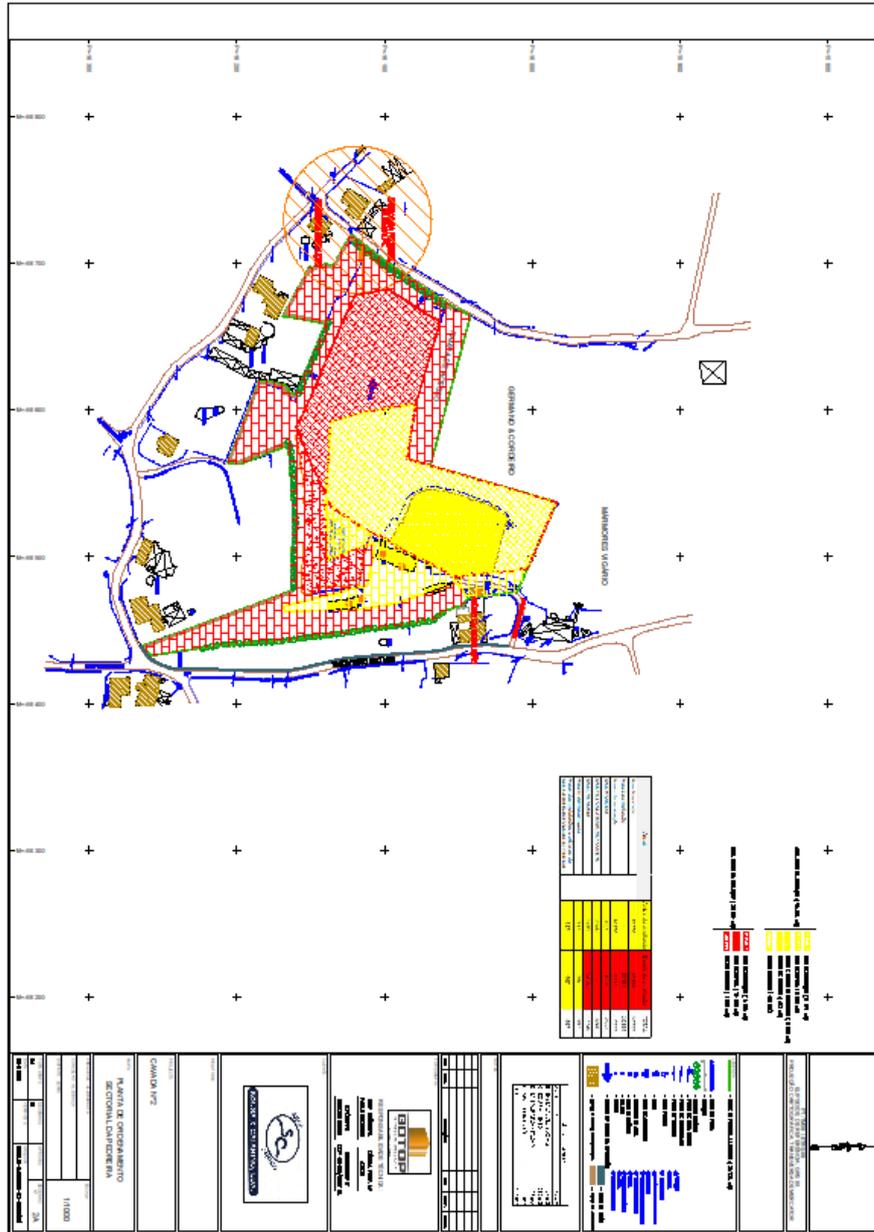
Planta de áreas (ver Planta 2A, em anexo)
